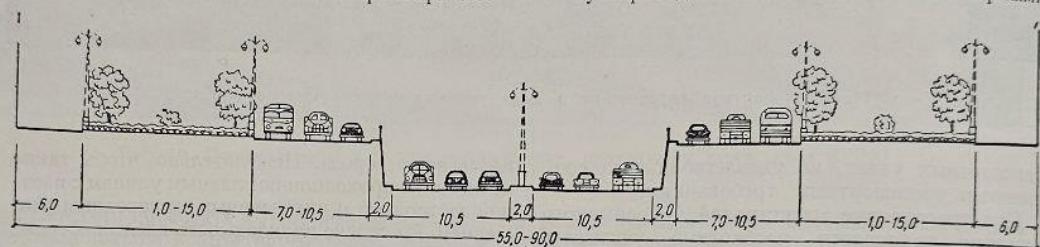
Поперечный разрез пандуса с подпорными стенками на подходах к путепроводу тоннельного типа
